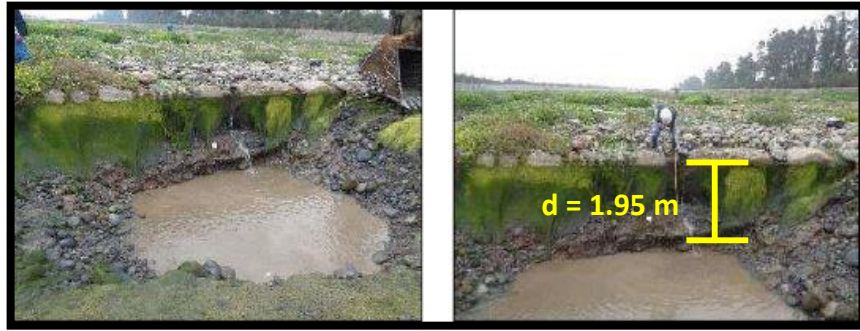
capa inferior de poca altura, por deterioro de concreto de la pantalla 24
